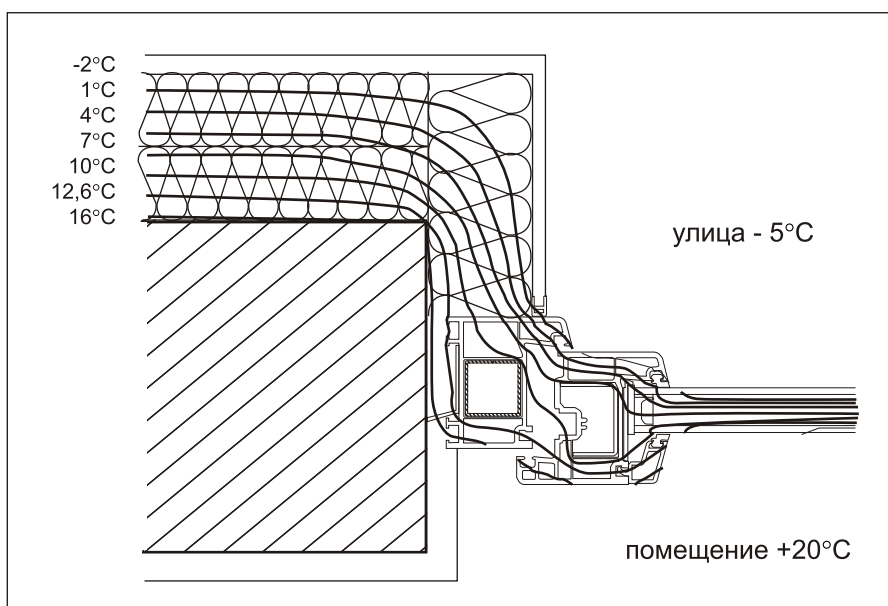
Бетонная стена с наружной изоляцией, пластиковое окно в середине проема, изолированные откосы
